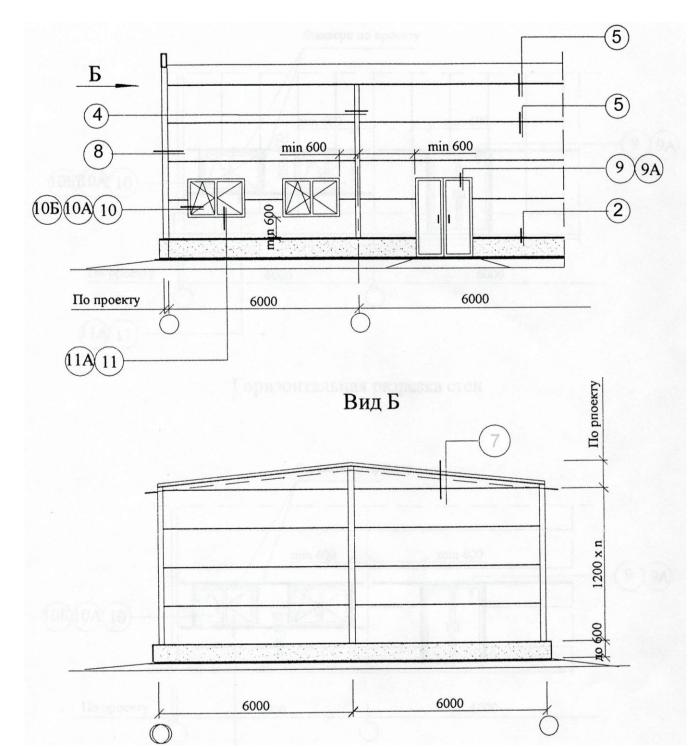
Фасад здания с горизонтальной раскладкой стеновых панелей
